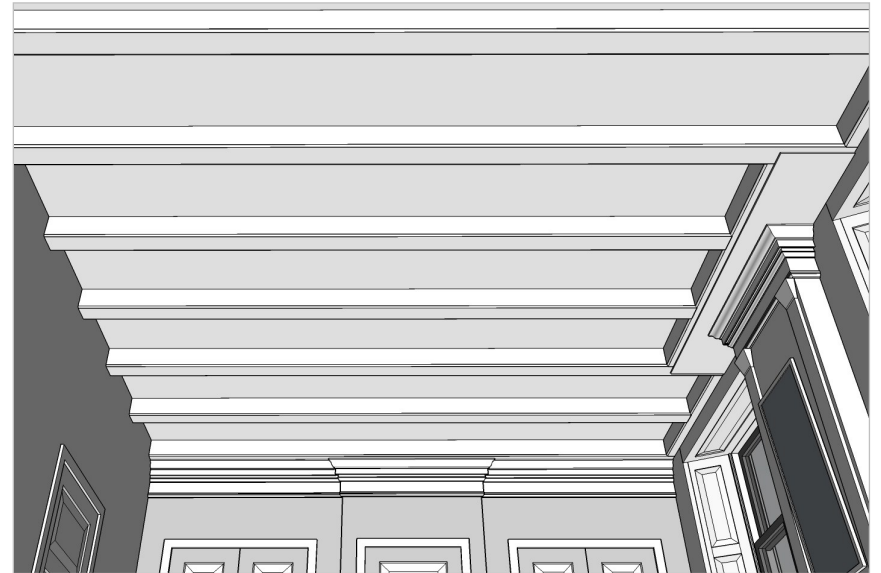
Overzichtsfoto (3): wand tegenover binnenkomst
